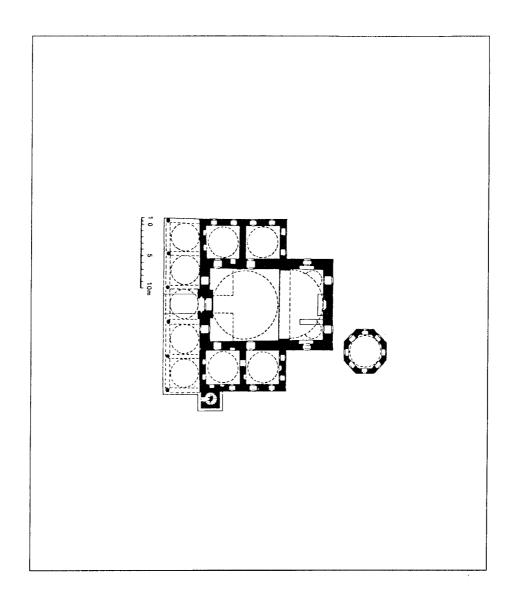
مسقط أفقي لمسجد بايزيد يلدريم أو مسجد خداونكار في أدرنة (عن ايفردي) .
